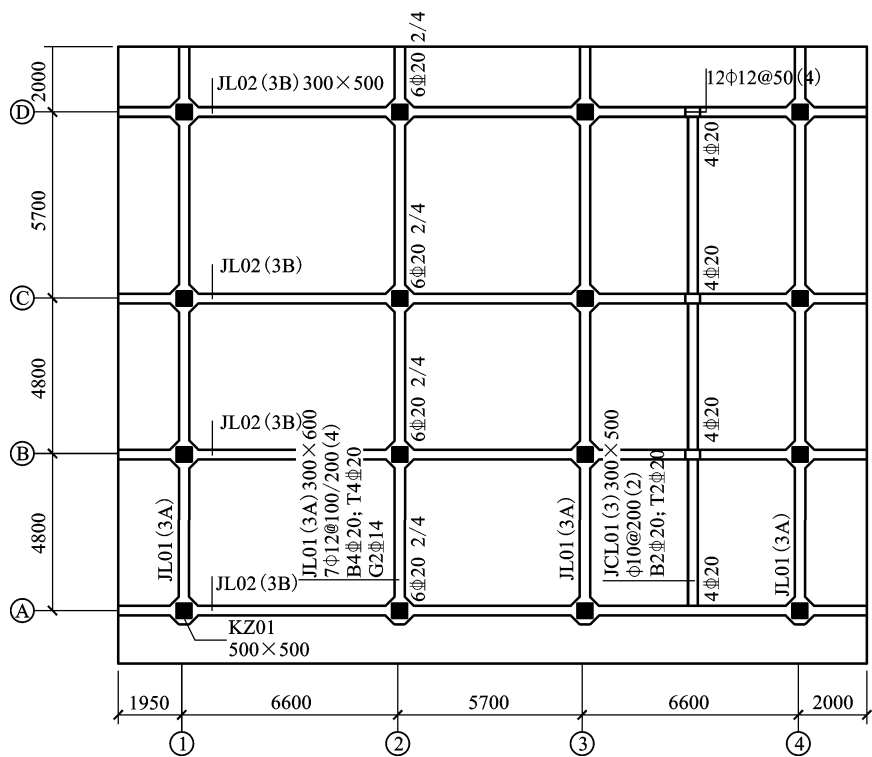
梁板式筏形基础基础主梁、基础次梁平法施工示意图
